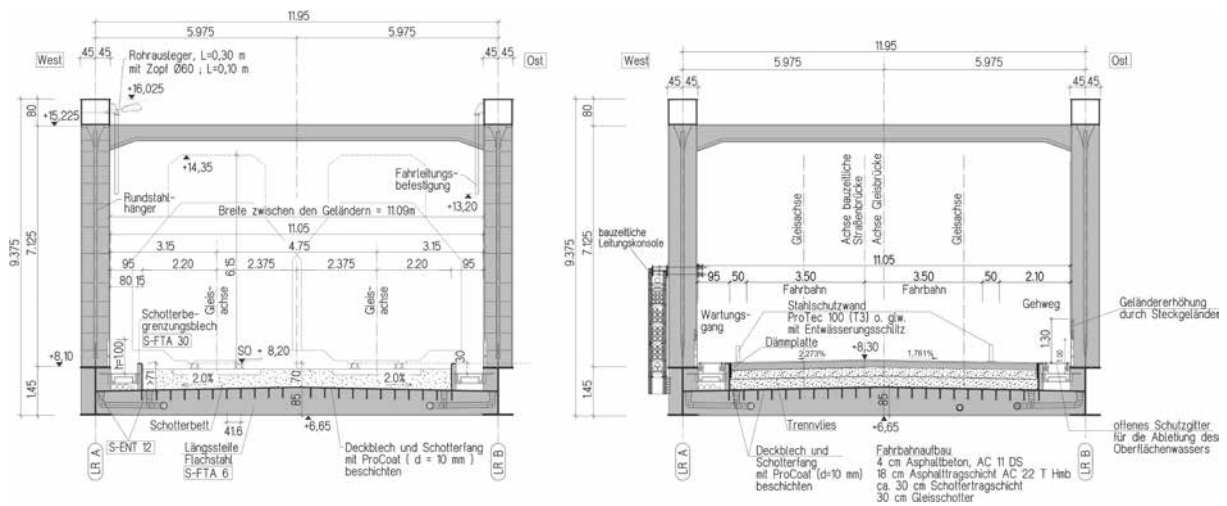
Querschnitt des 2-gleisigen Eisenbahnbrückenüberbaus; links mit endgültiger Gleistrasse, rechts mit temporärer Straßentrasse und Leitungsüberführung.
